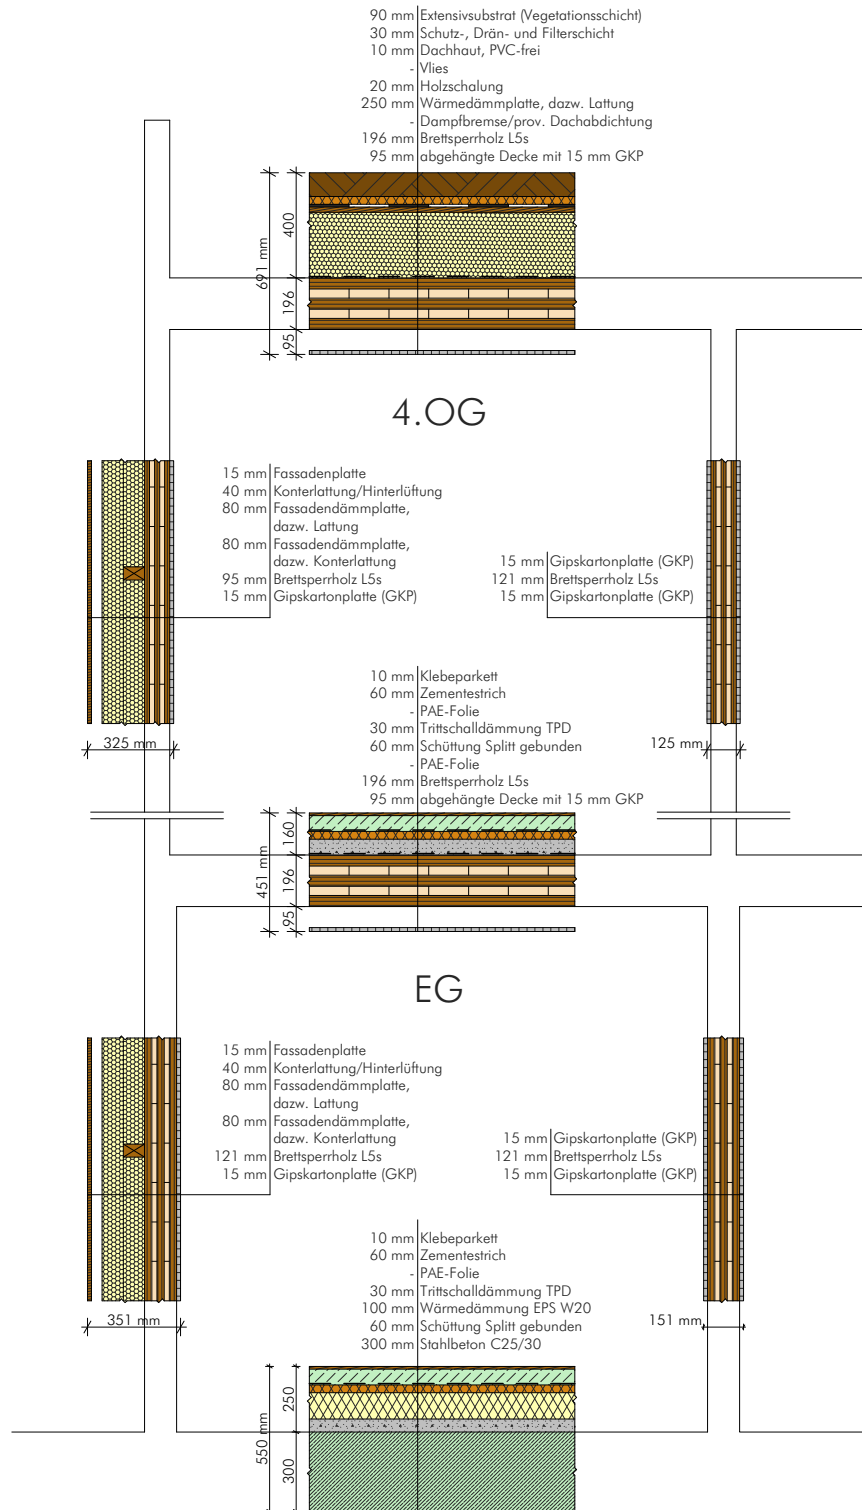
Situierung der Bauteilaufbauten anhand eines Fassadenschnittes
